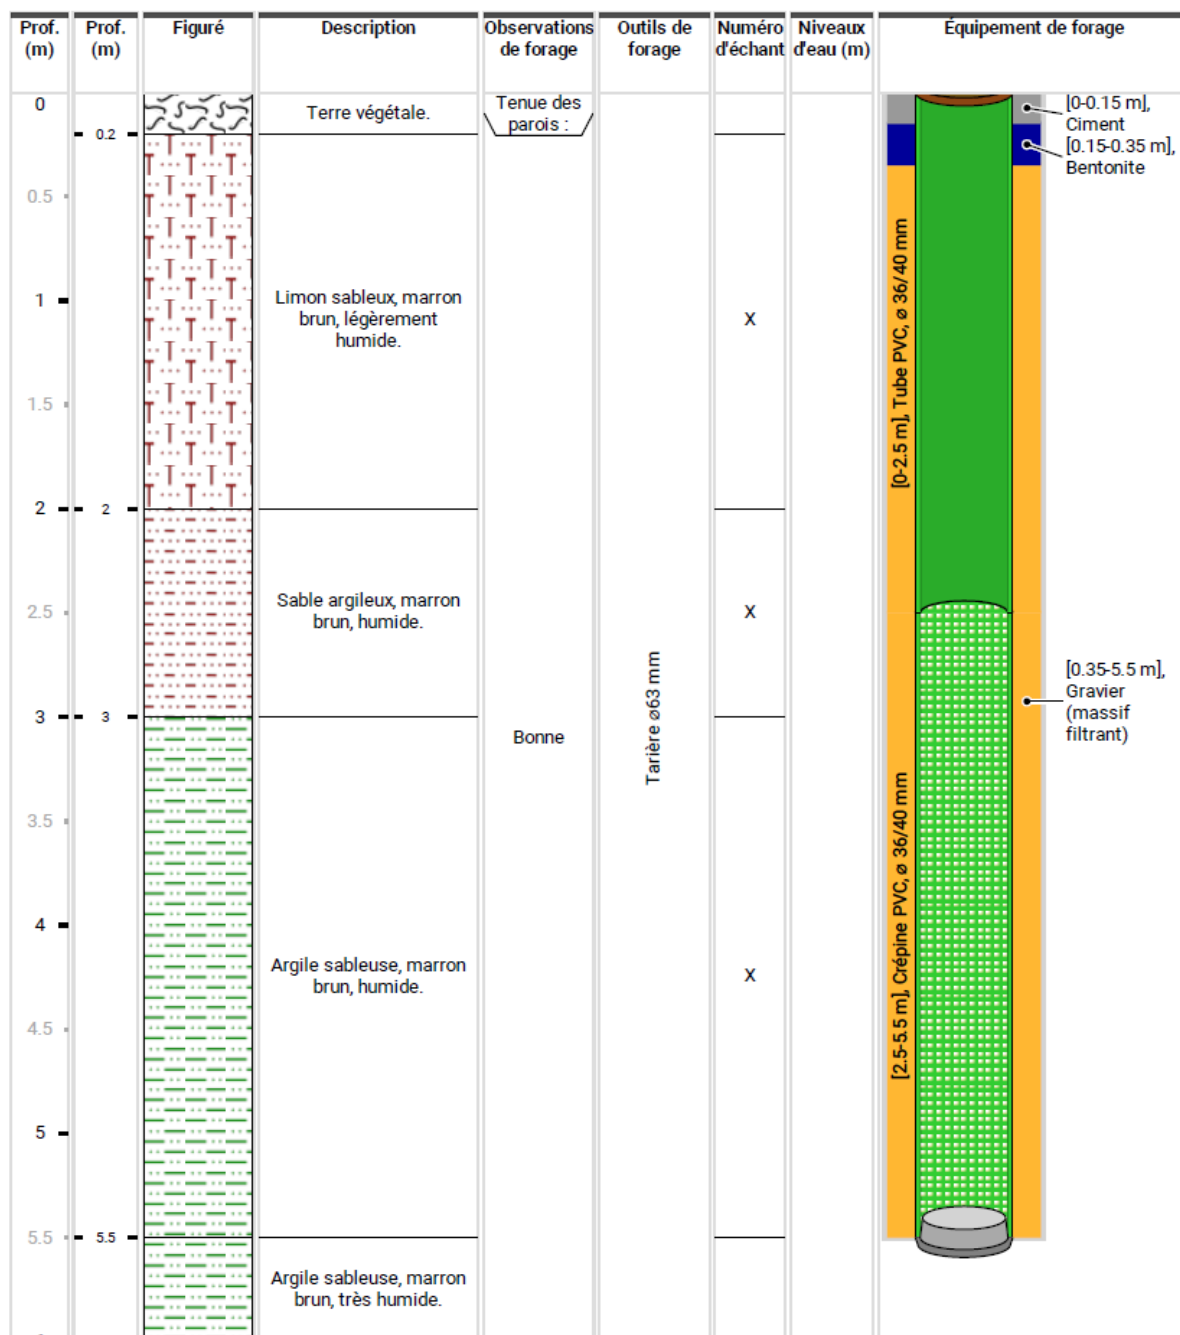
Coupe du sondage SD1 / Pz et de son équipement
